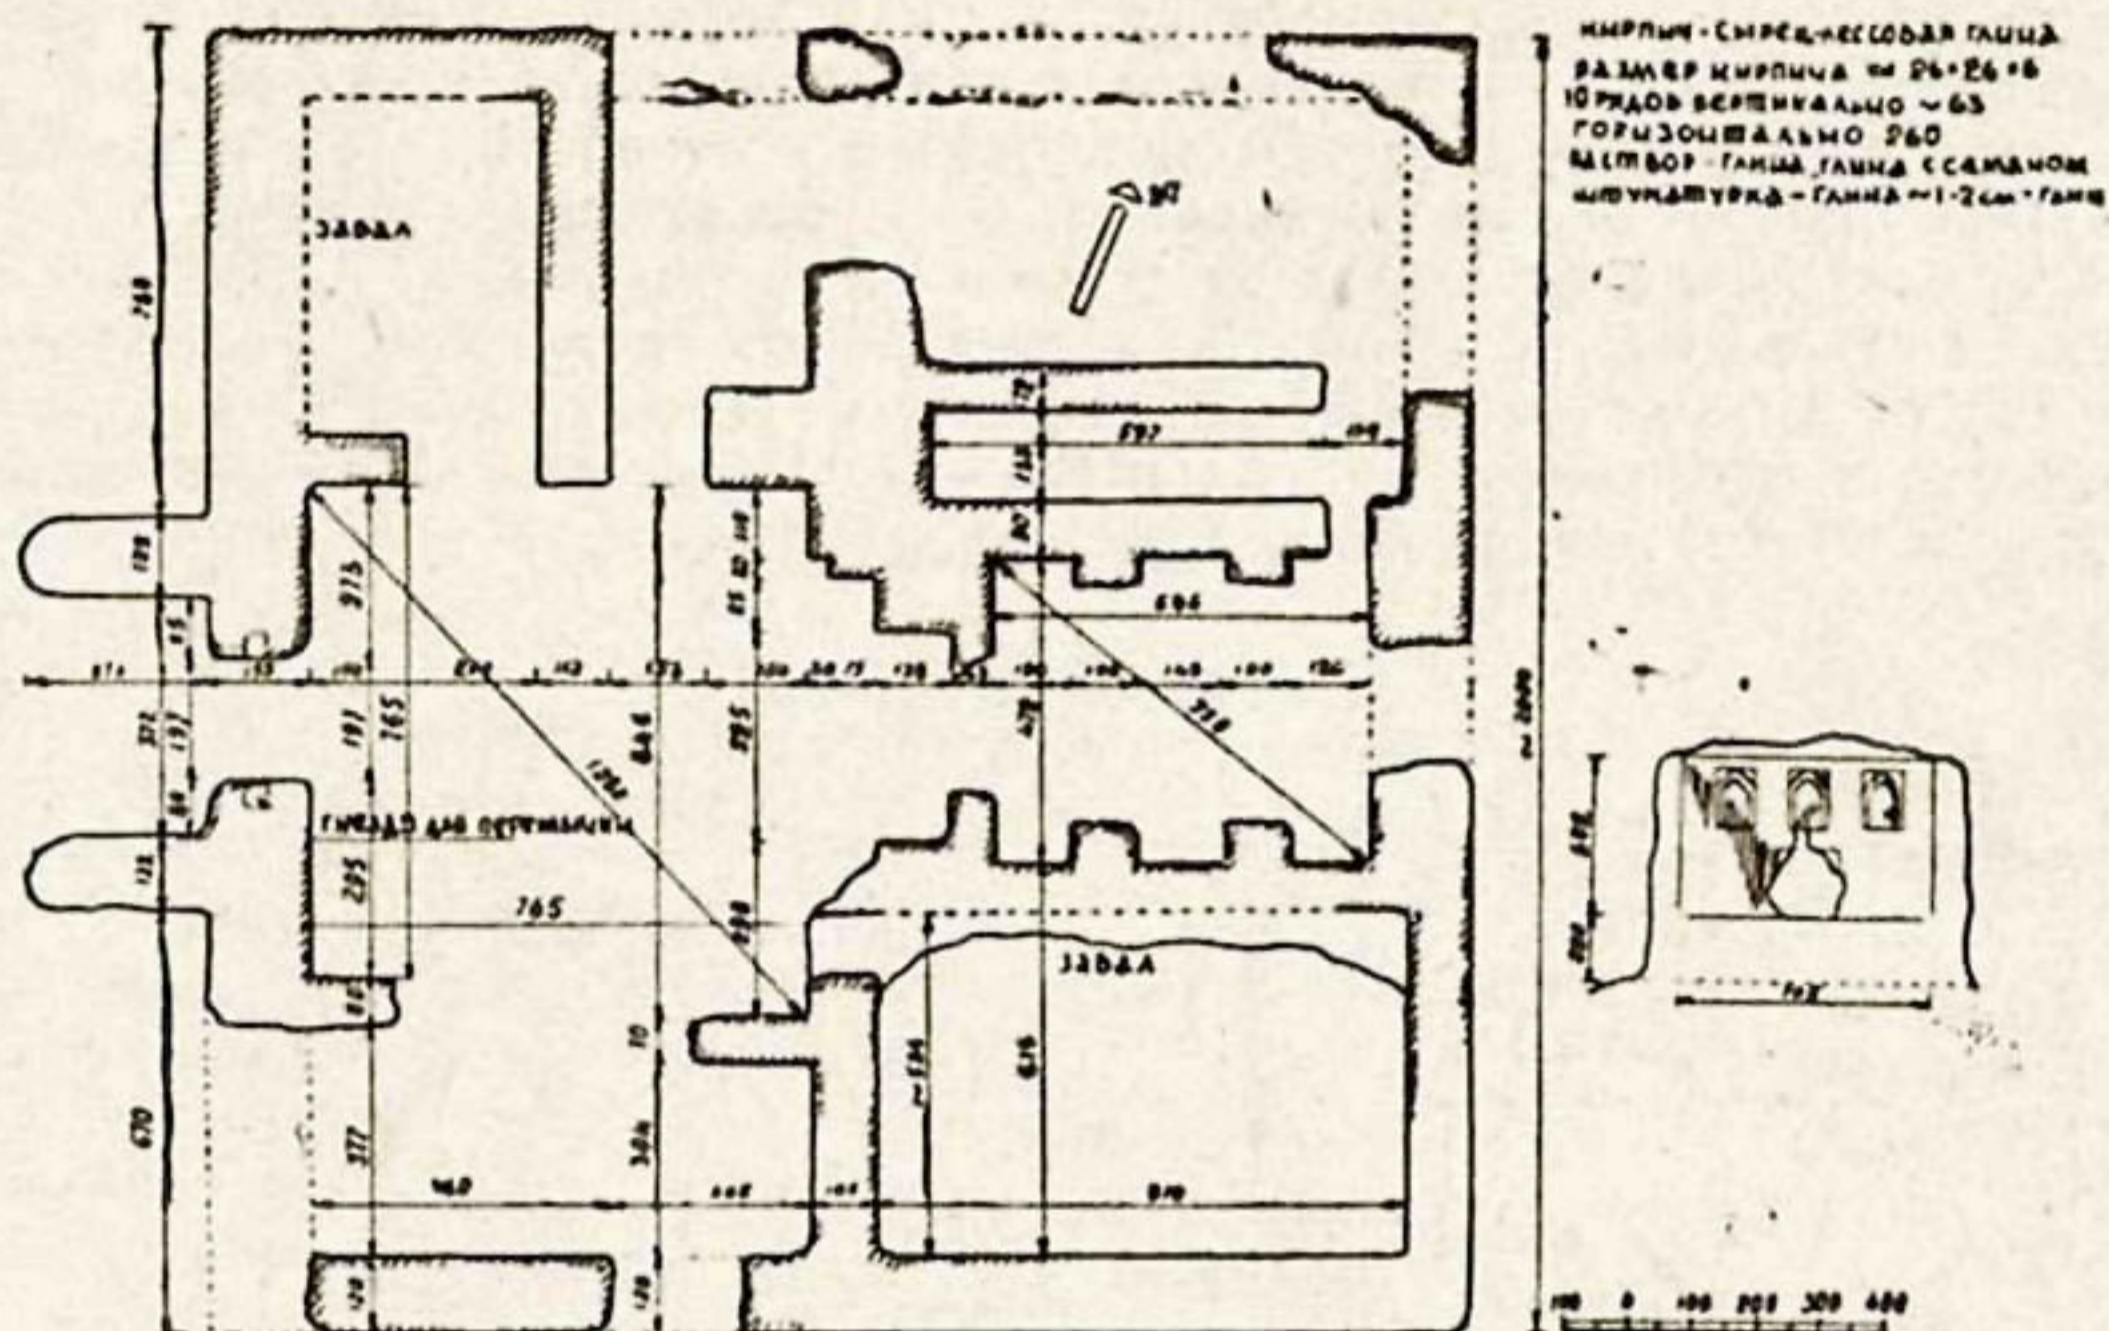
План сырцового здания № 6 и разрез через первое после входа помещение.
